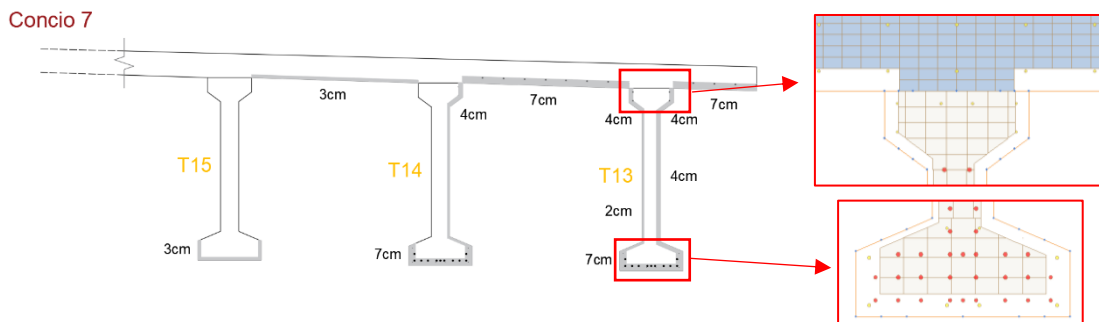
Ponte sul torrente Mavigliano, Caso I_ev5 sezione trasversale Concio 7 + dettagli Midas Civil
